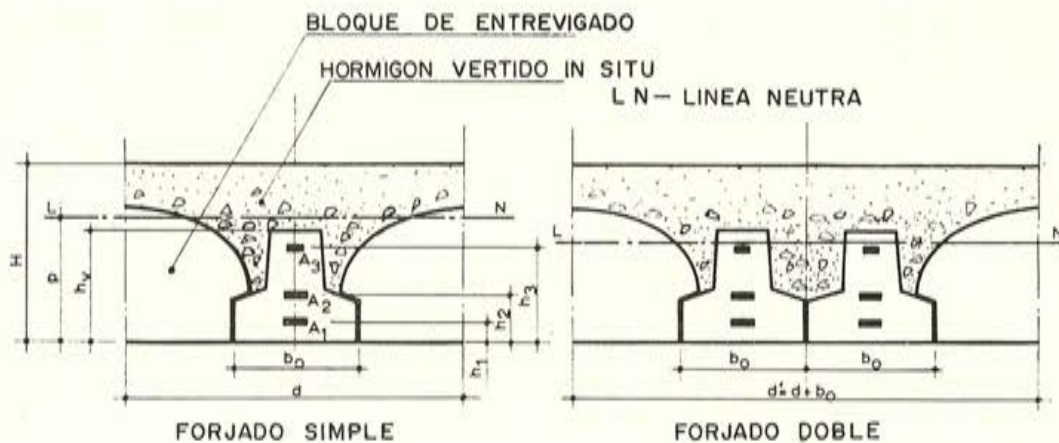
Secciones de forjados prefabricados construidos a base de viguetas de hormigón pretensado.
